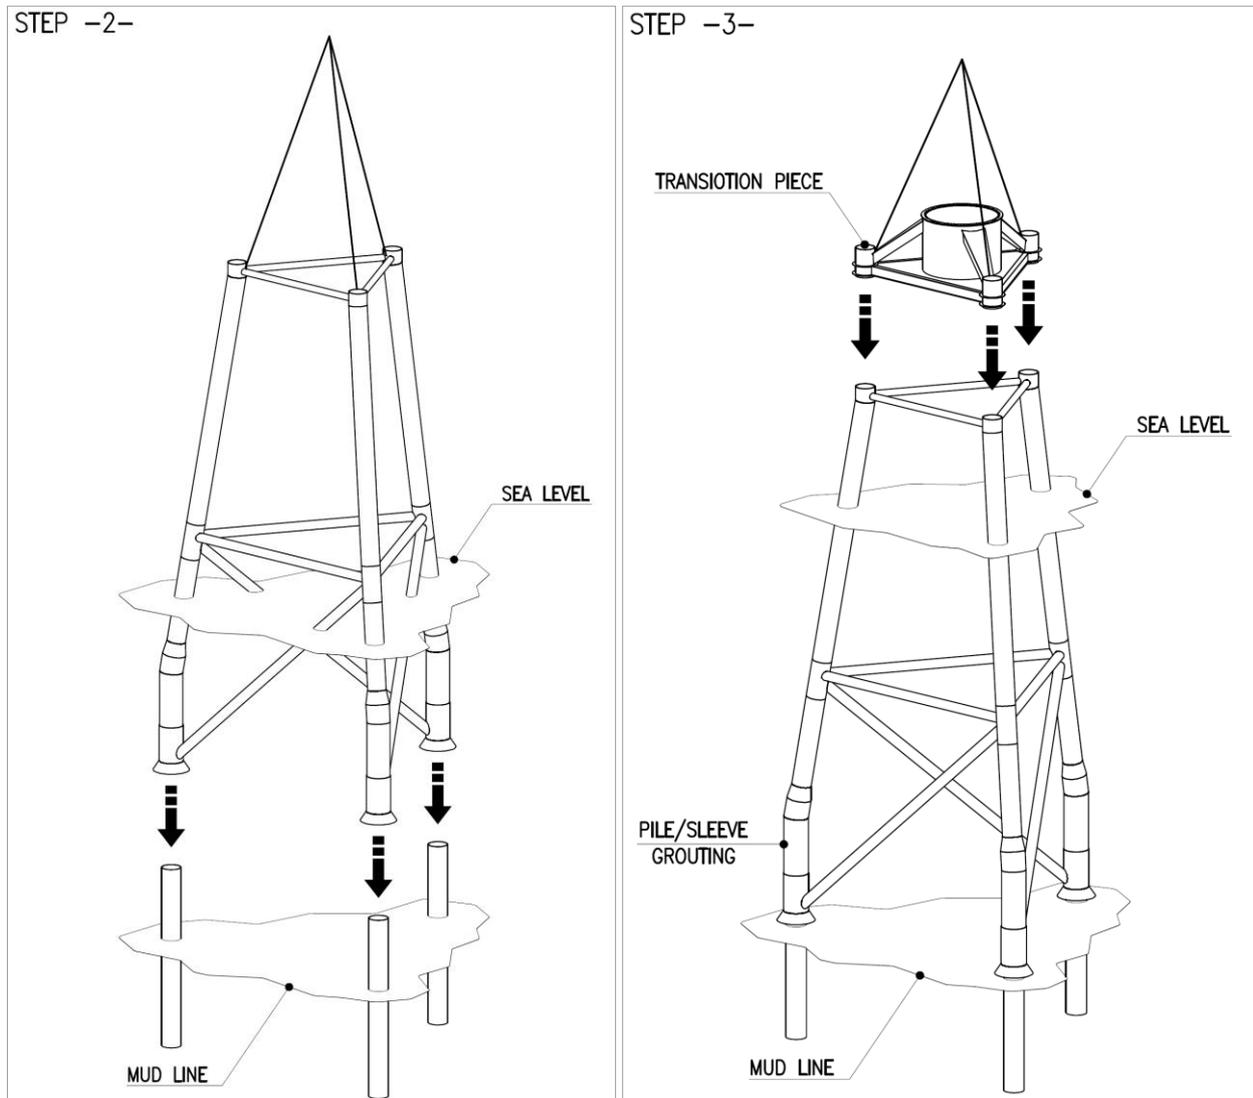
a sx Fase 2- installazione jacket. A sx, Fase 3- cementazione pali
